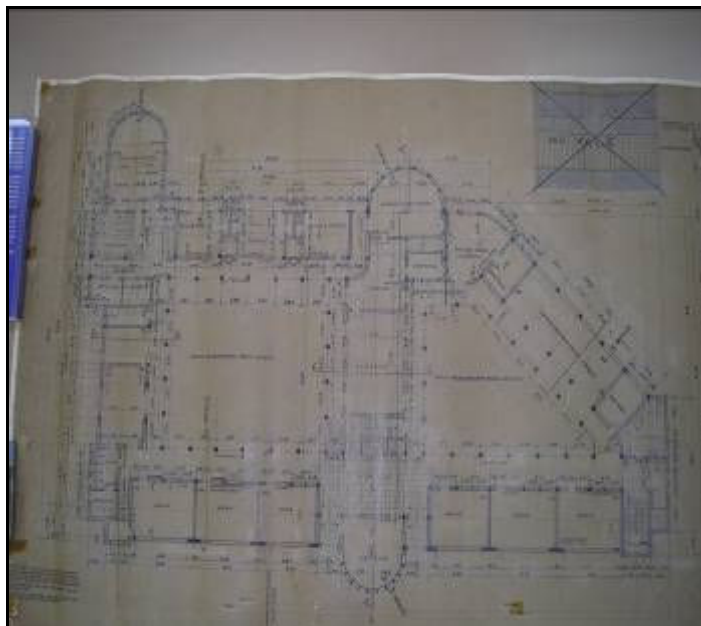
Plano de Arquitectura de la unidad educativa experimental nacional Venezuela. Planta Baja.
